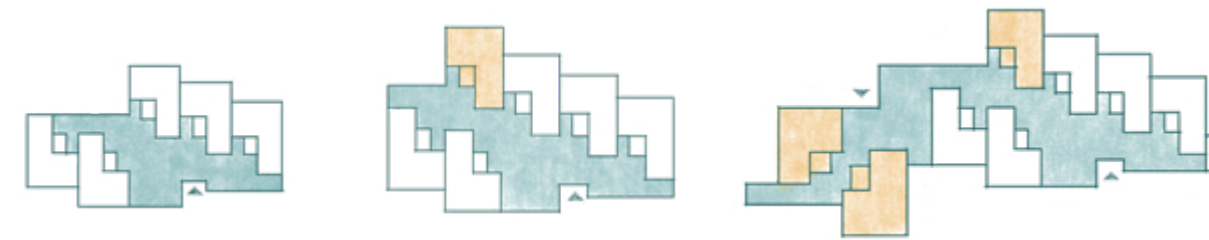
Espacio exterior. Fuente: arquitecturaviva.com
